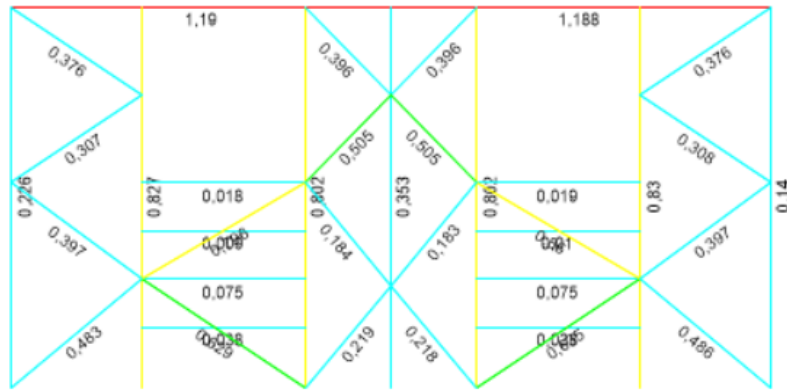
Factores de utilización vista en planta elevación 12.3 m.
